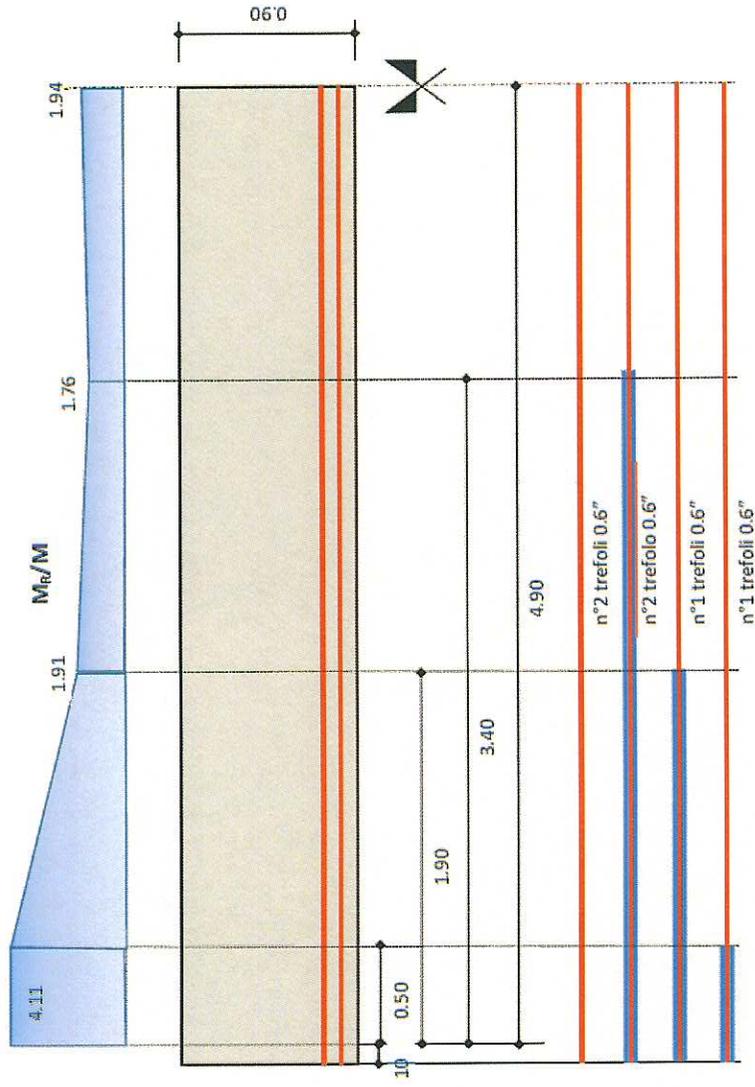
Schema della disposizione dei cavi nel tegolo da 2.0 m e rappresentazione del rapporto  $M_R/M$ .
